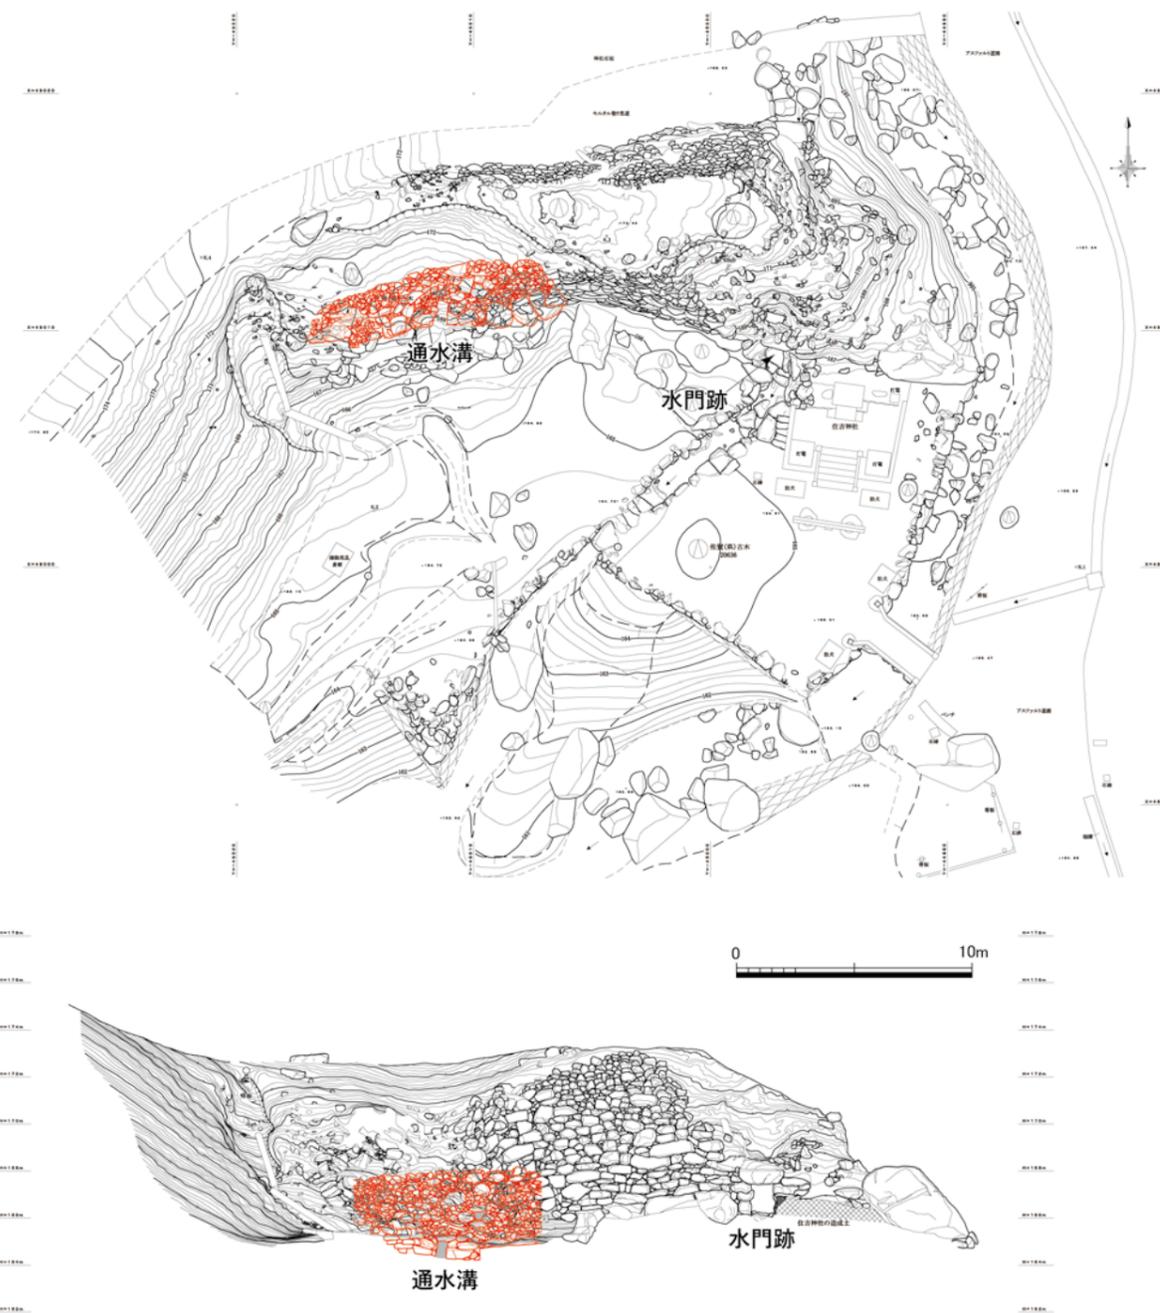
基肄城跡の水門・通水溝 1～3 平面・立面図 (1/300)
